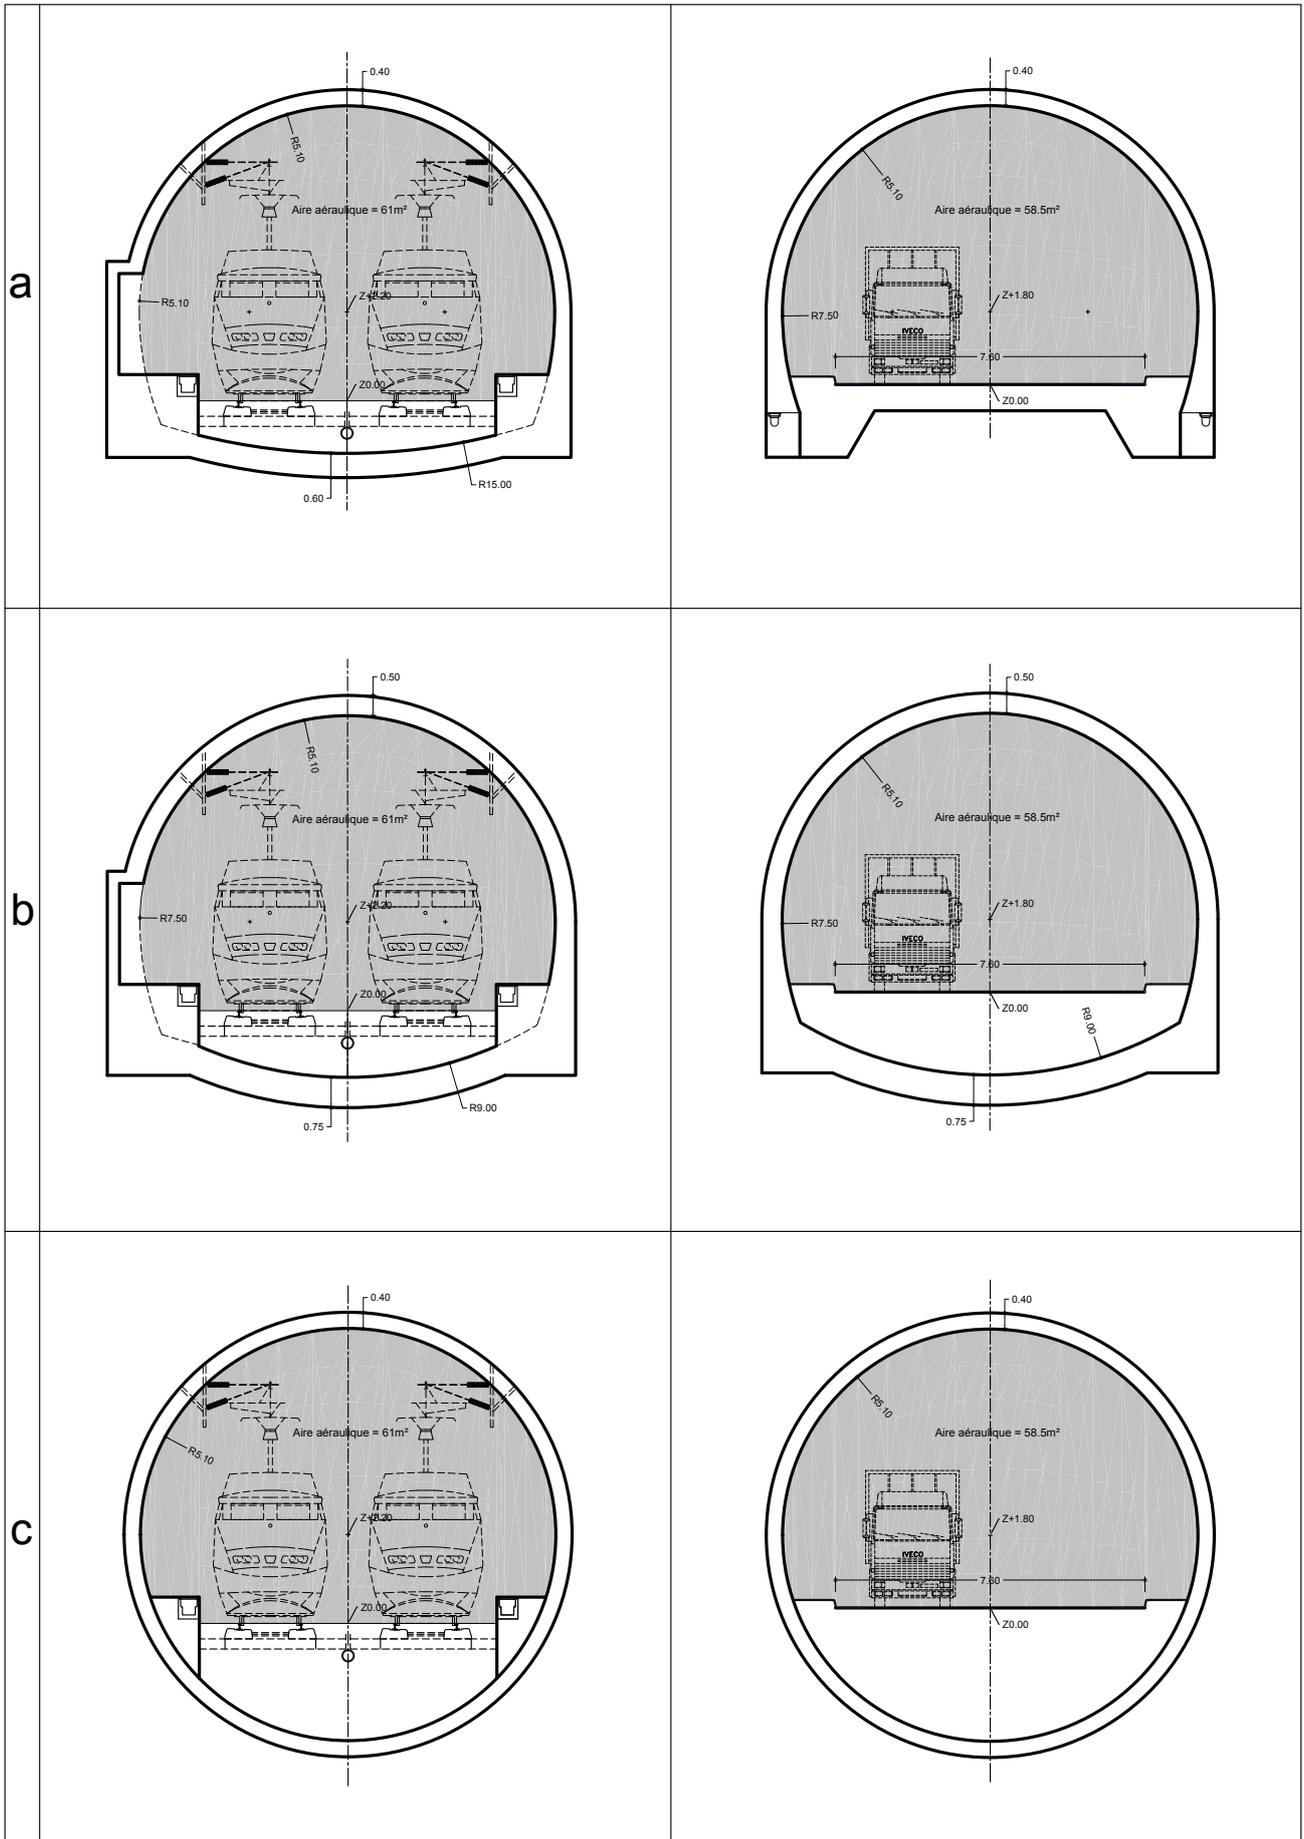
Sections transversales pour la géométrie D10 (à gauche : tunnels ferroviaires, à droite : tunnels routiers)
